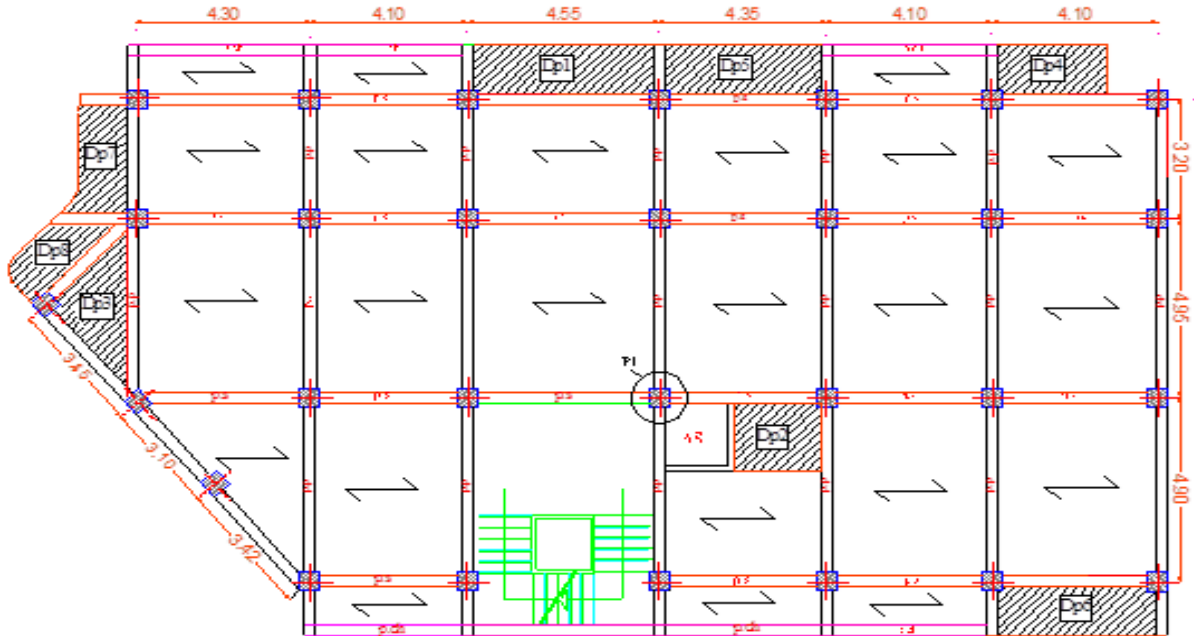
Schéma de la disposition des poutrelles pour les étages courants.
